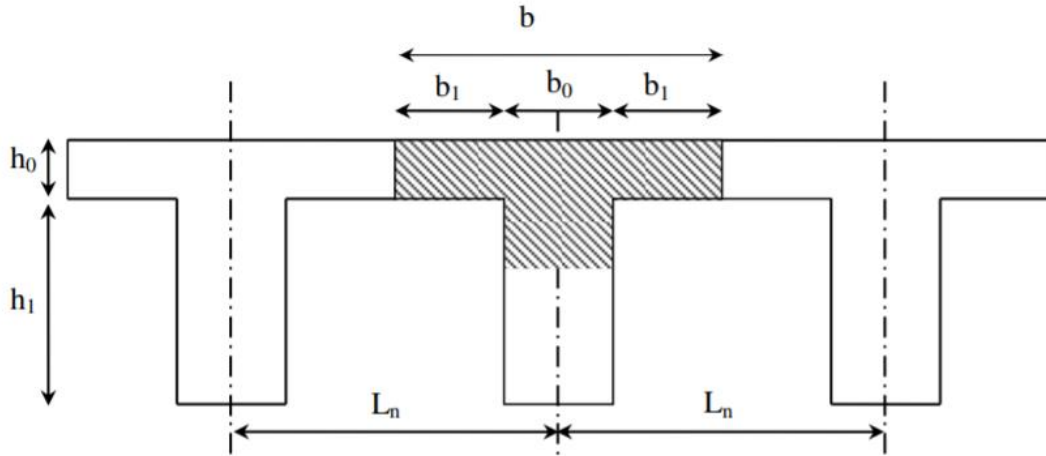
Coupe transversale d'un plancher à corps creux
